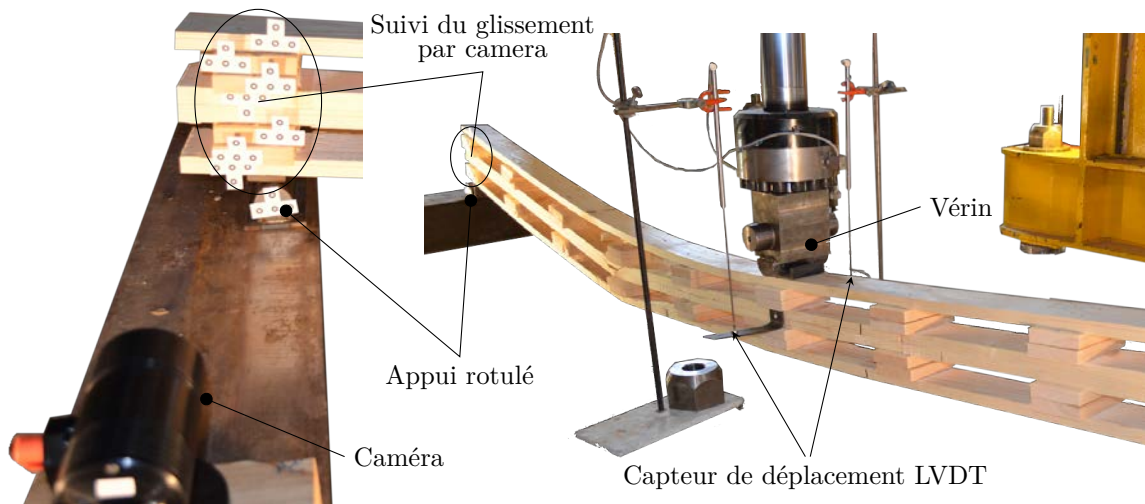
Appareils de mesures pour la flexion 3 points d'une poutre ajourée
